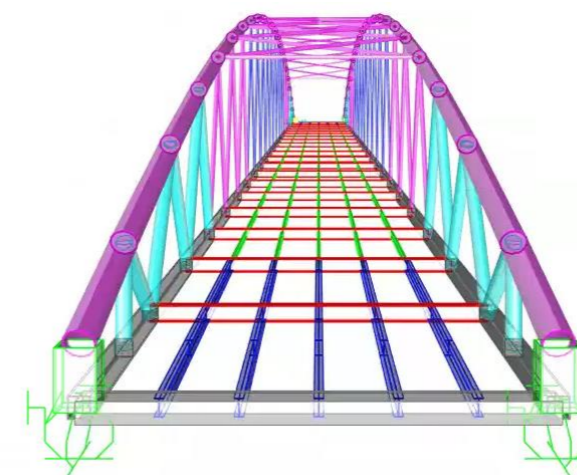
Vista alzado entrada. Modelo 3D de cálculo.
